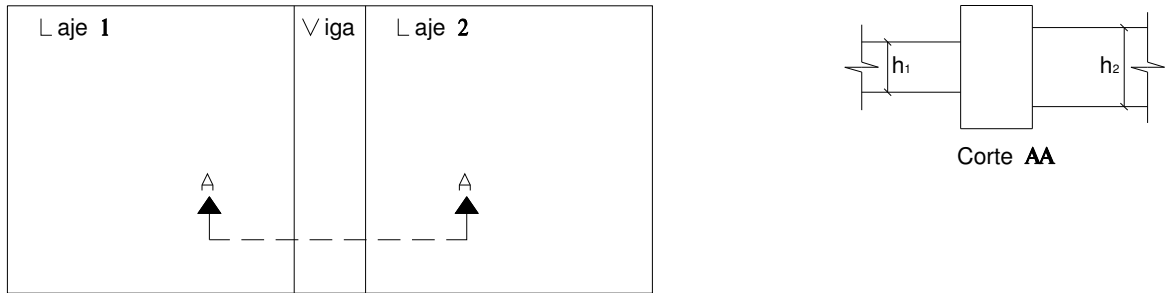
Pavimento com 2 Lajes e 1 Viga
